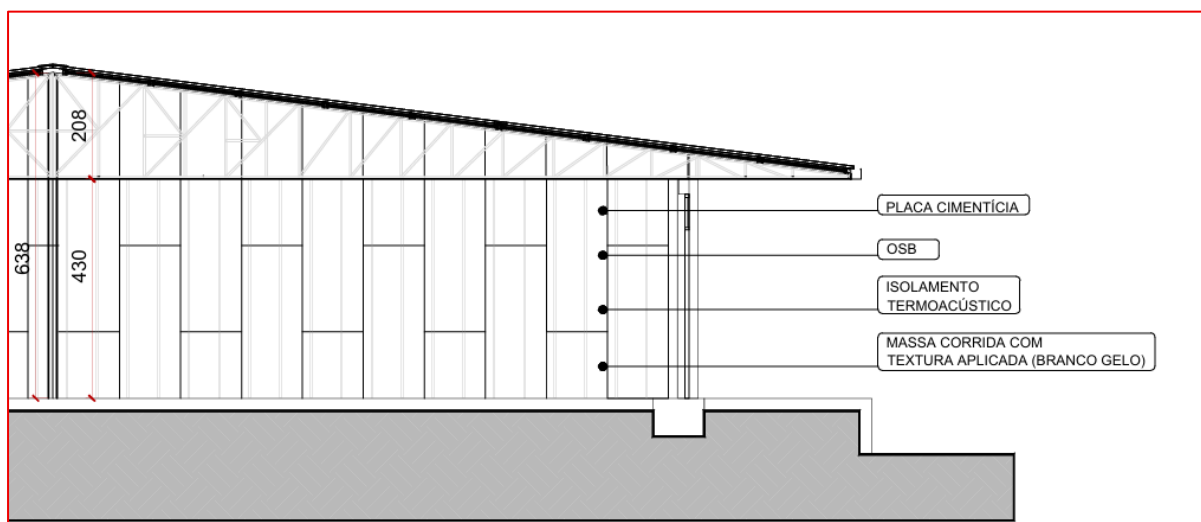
Corte esquemático elevação da parede em Steel Frame. Fonte: Projeto.
